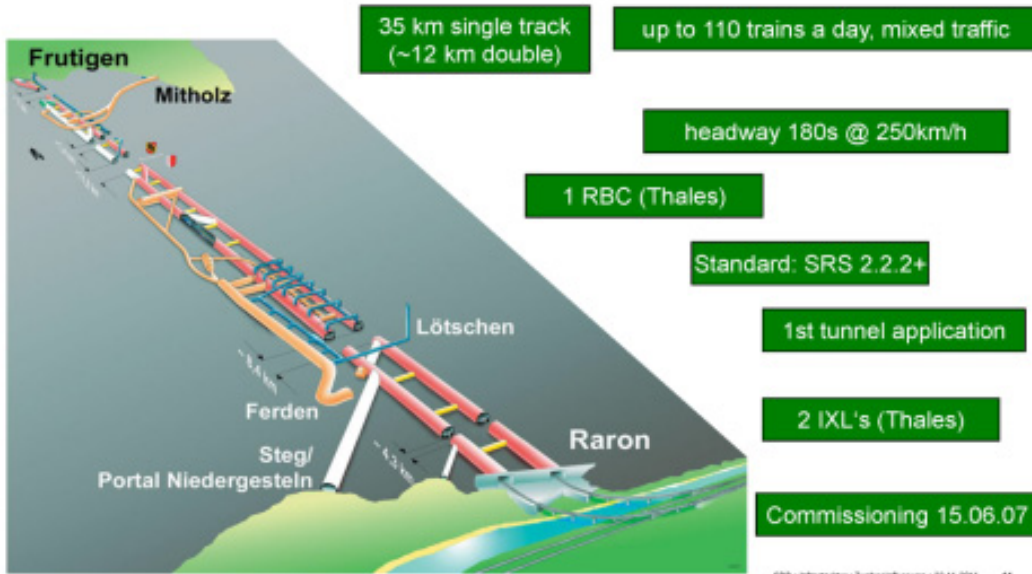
Lötschbergtunnel 隧道 ERTMS 系統示意
